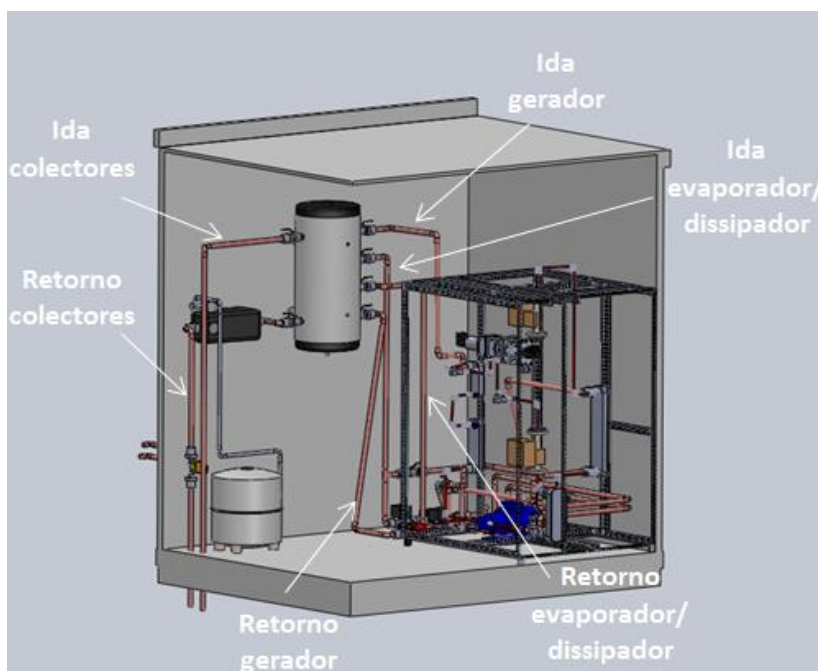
Desenho tridimensional da casa das máquinas com equipamentos e tubagem.
